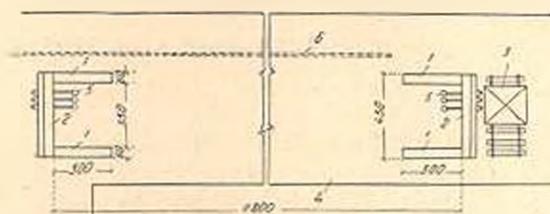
Схема стенда по изготовлению струнорезных элементов экспериментально-производственной базы АН СМ. 1—железобетонные упоры для восприятия горизонтального тягового усилия и 290 тонн; 2—стальная упорная балка (траверс); 3—гидродомкрат СМ—513 на рельсовом пути; 4—бетонная площадка; 5—струнодержатели; 6—паропровод.
